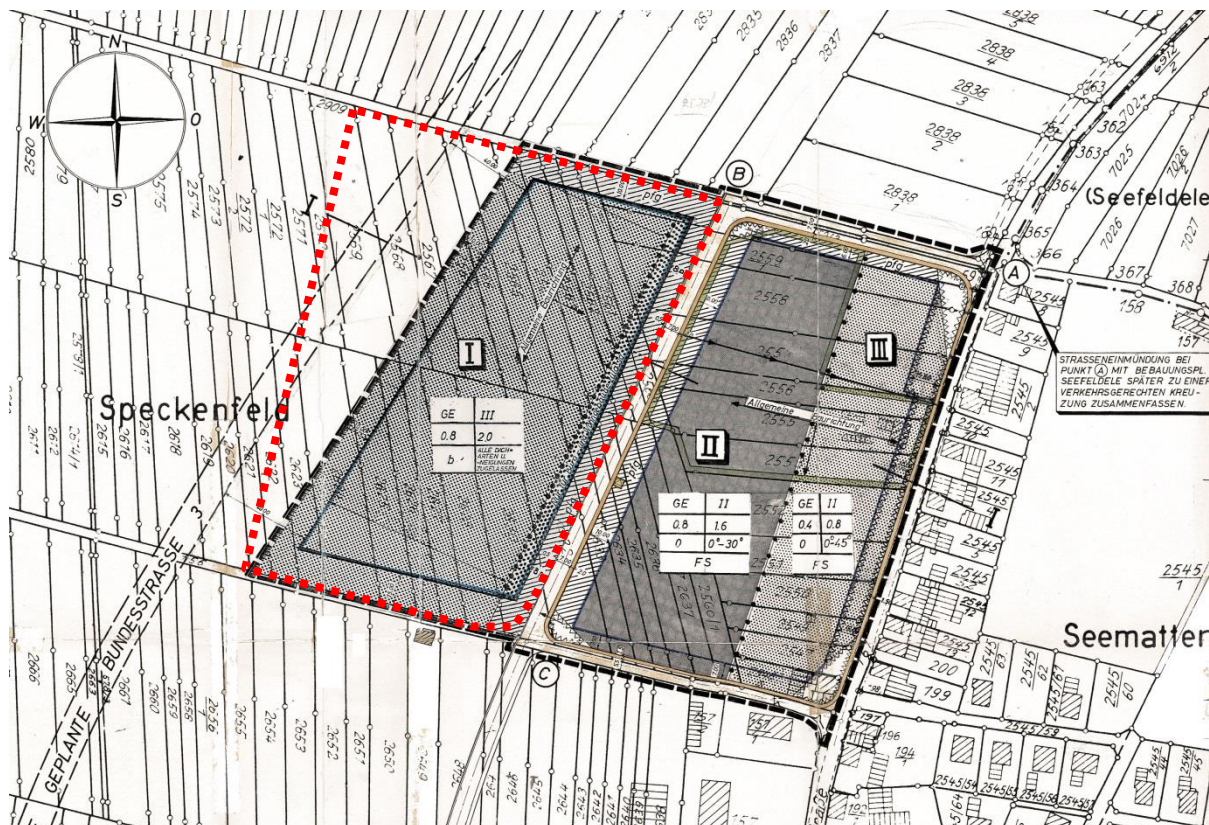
Bebauungsplan "Speckenfeld" i.d.F. der 1. Änderung (1984) (Änderungs- und Erweiterungsbereich rot markiert (vereinfachte Darstellung))
